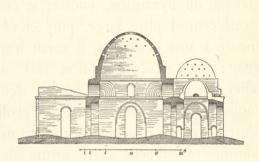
Palais de Sarvistan. Coupe longitudinale.
